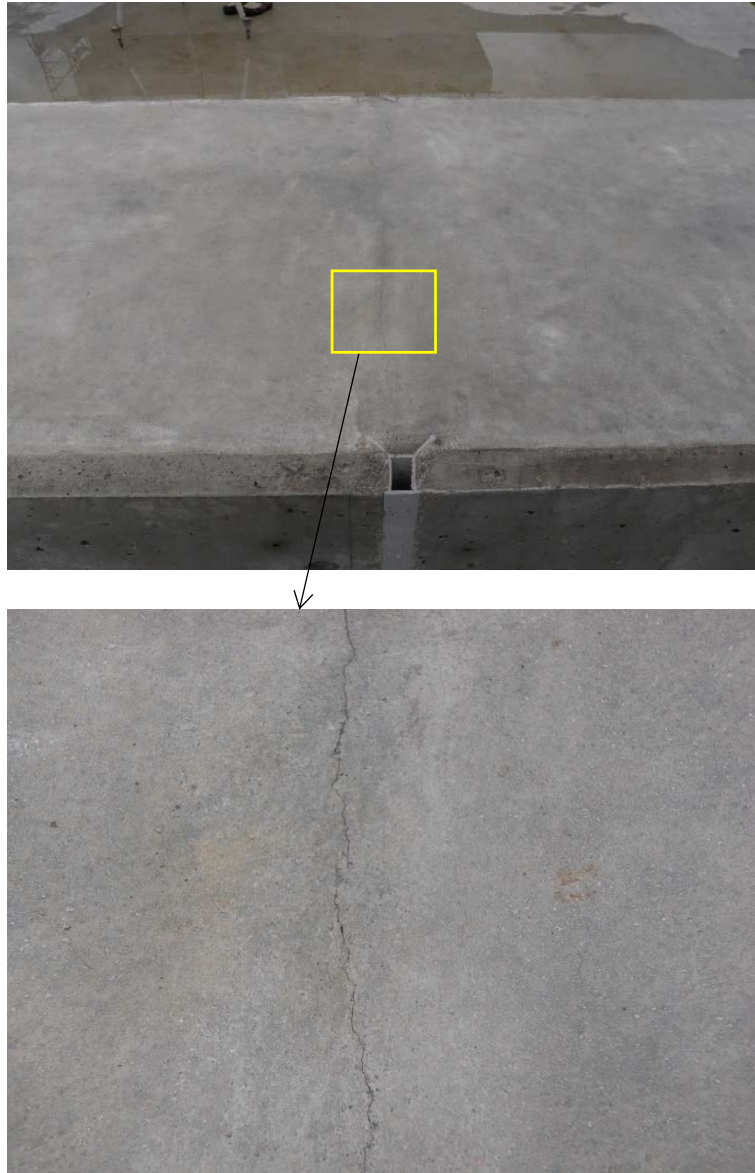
部材上面で確認できる目地上ひび割れの例
